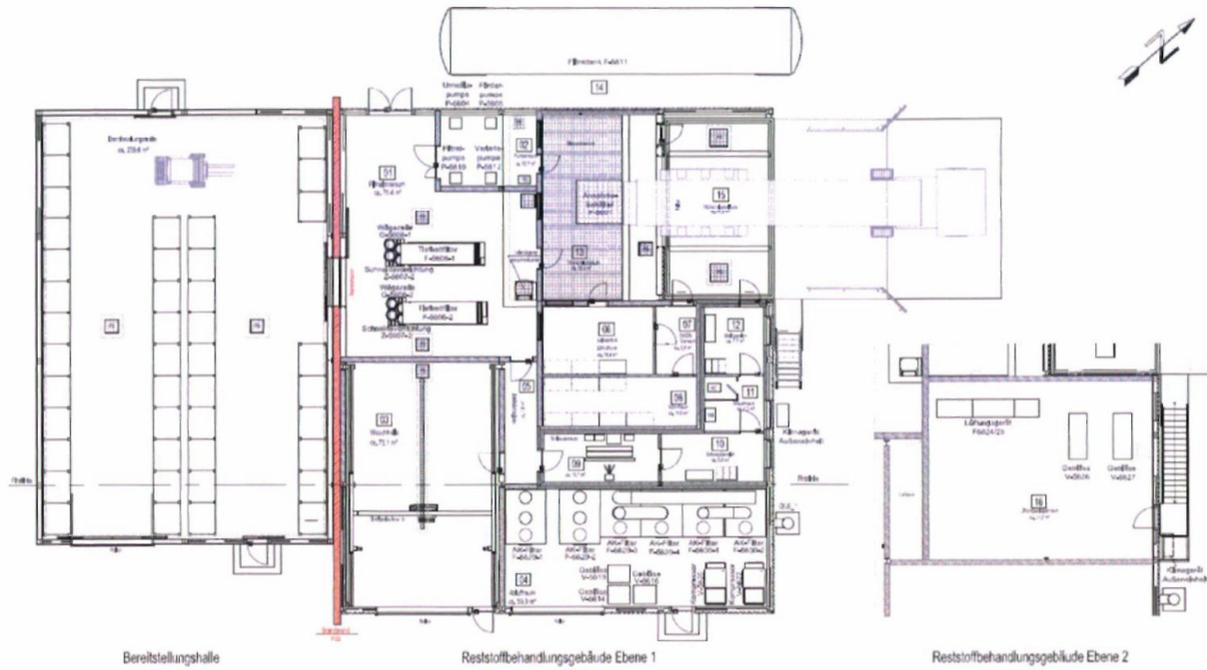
Gebäudeplan der Reststoffbehandlungsanlage (Anlage 3)
